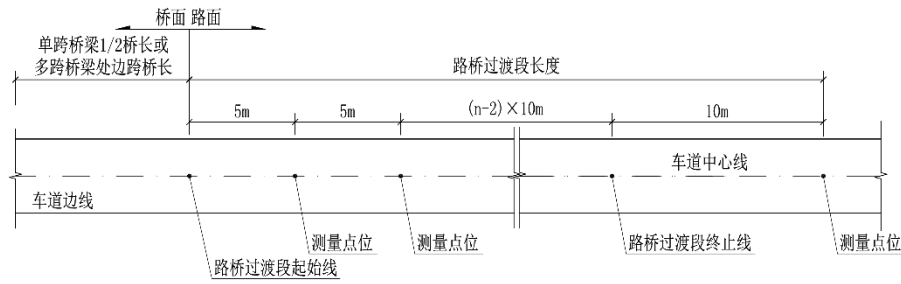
桥头不设搭板时纵坡测量平面示意图
